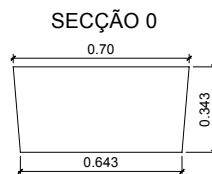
Secção transversal das divisões da carlinga (ponte sobre o rio Zambeze).
